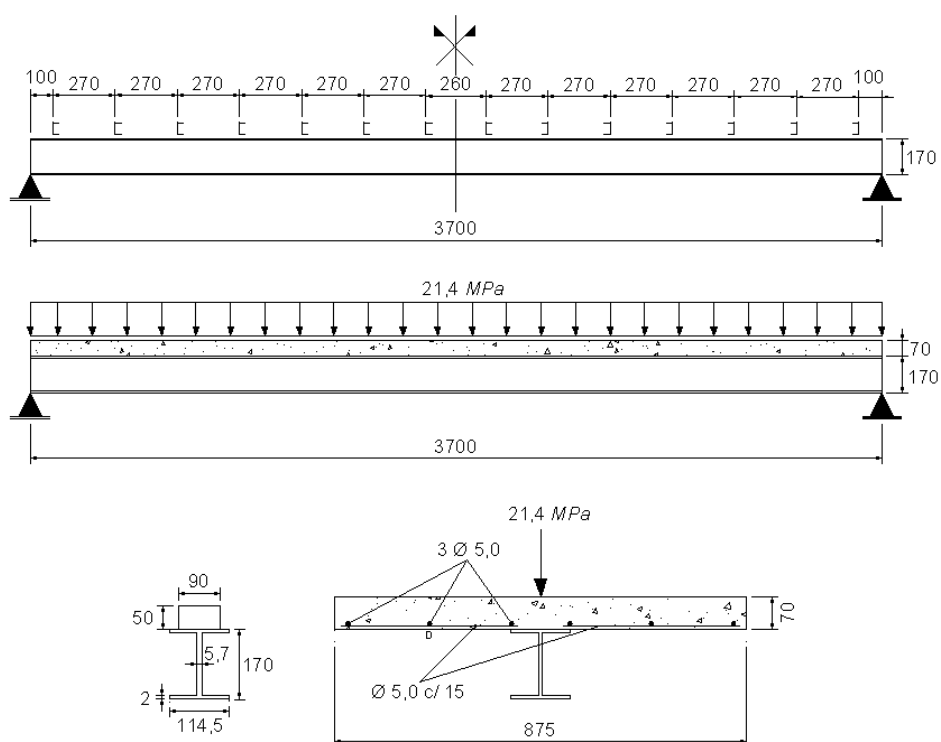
Vista lateral e transversal da viga mista.
